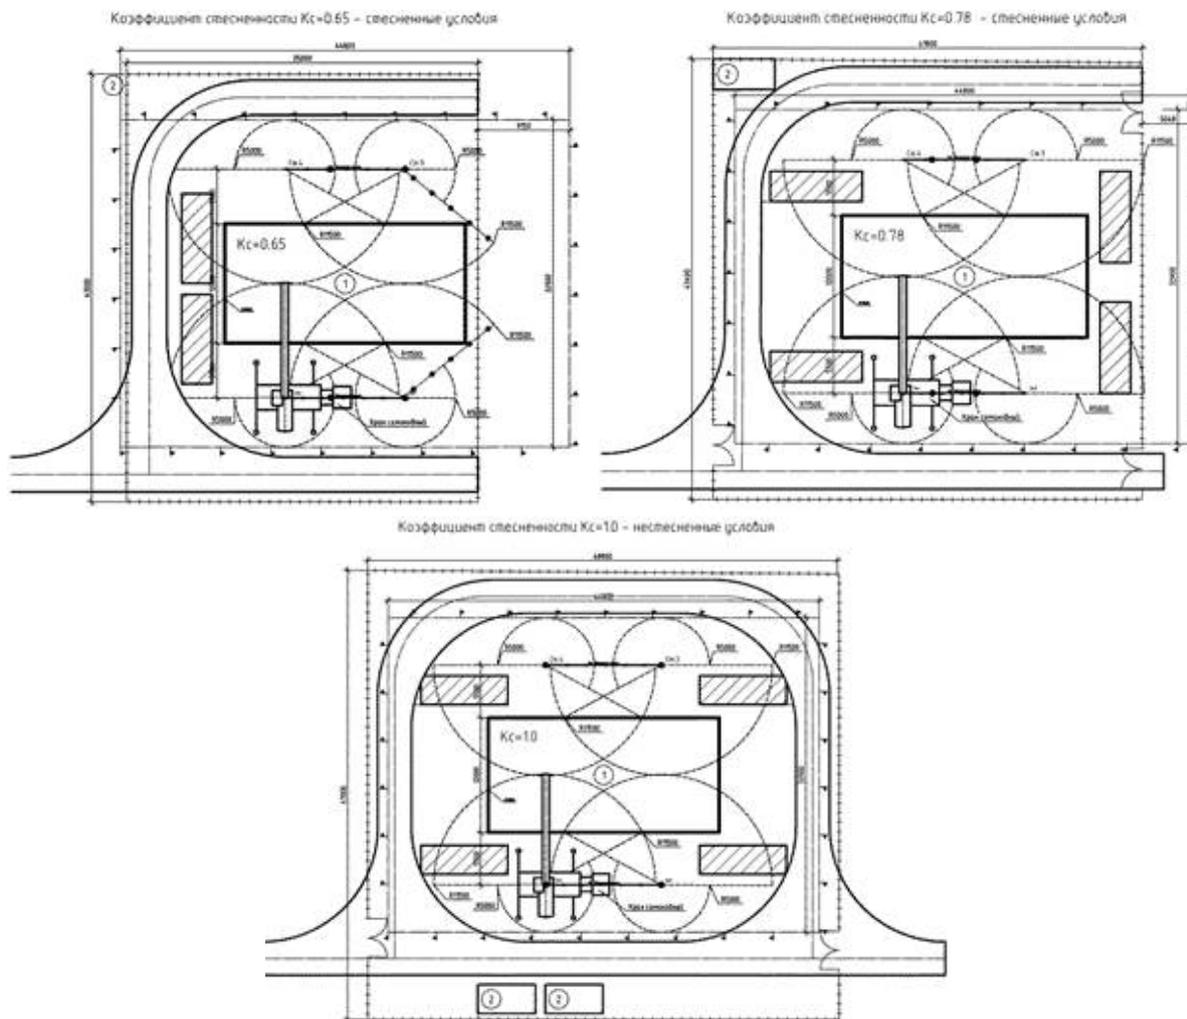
Организация строительной площадки при разборке конструкций самоходным краном
